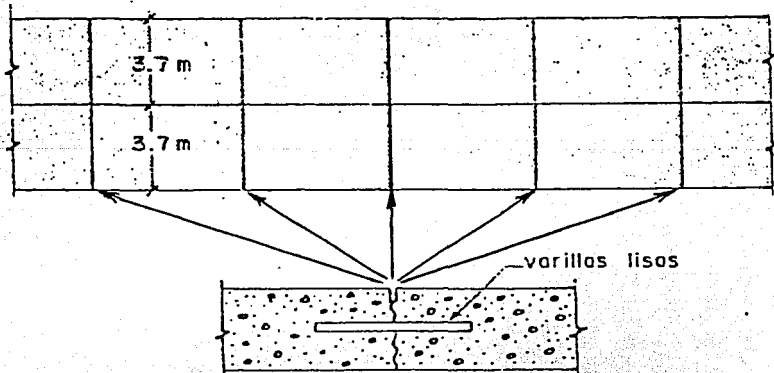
Pavimento de concreto simple con refuerzo en las juntas
